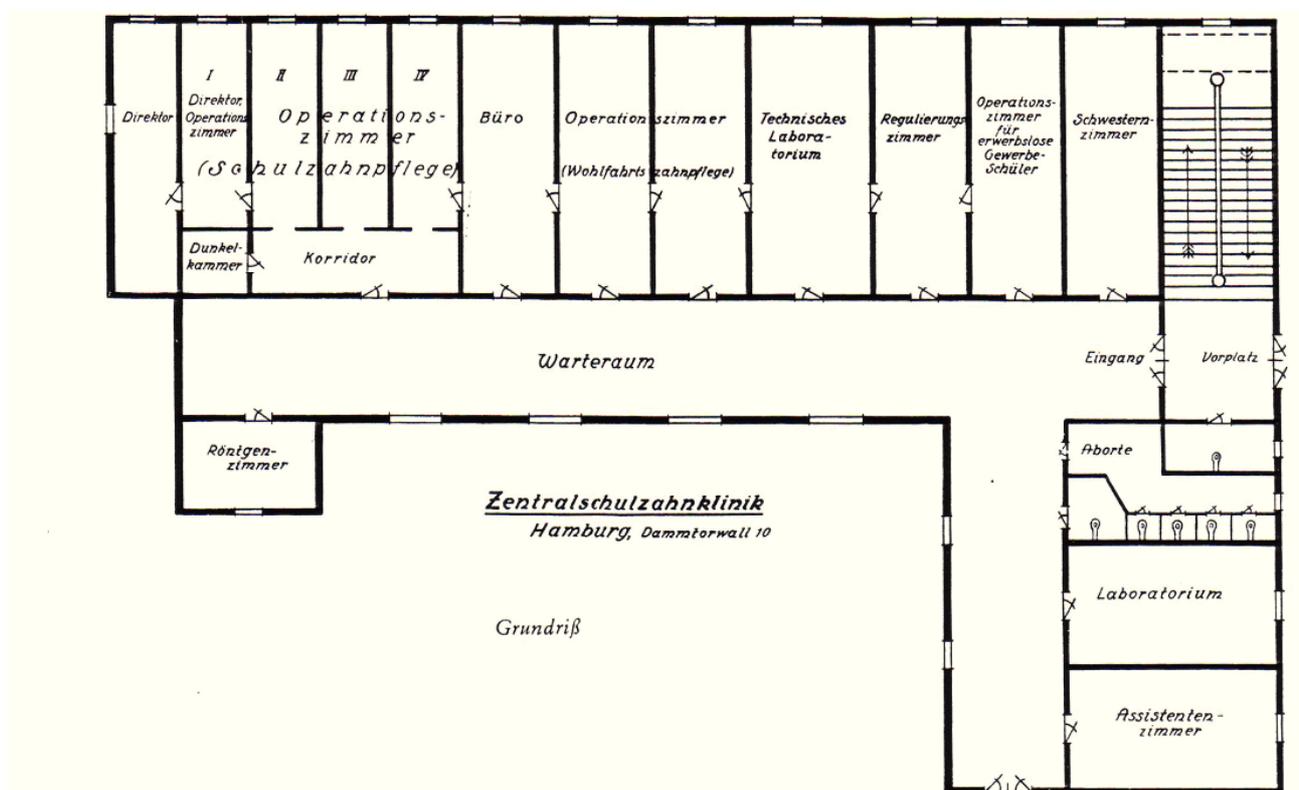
Grundriß der Zentral-Schulzahnklinik, Dammtorwall 10, rechts unten das Laboratorium, in dem Türkheim arbeitete (Glaubnitz 1928, S. 340).
